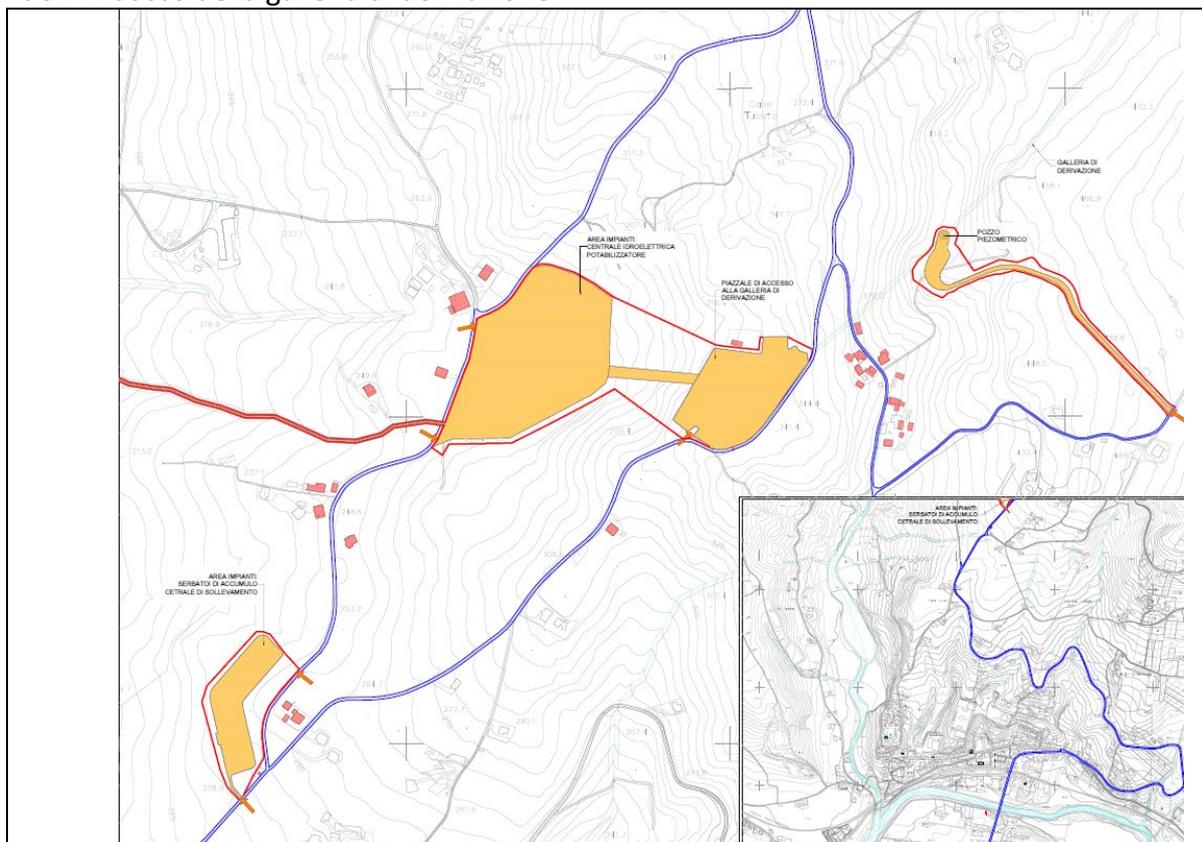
Layout progetto con individuazione dei cantieri
